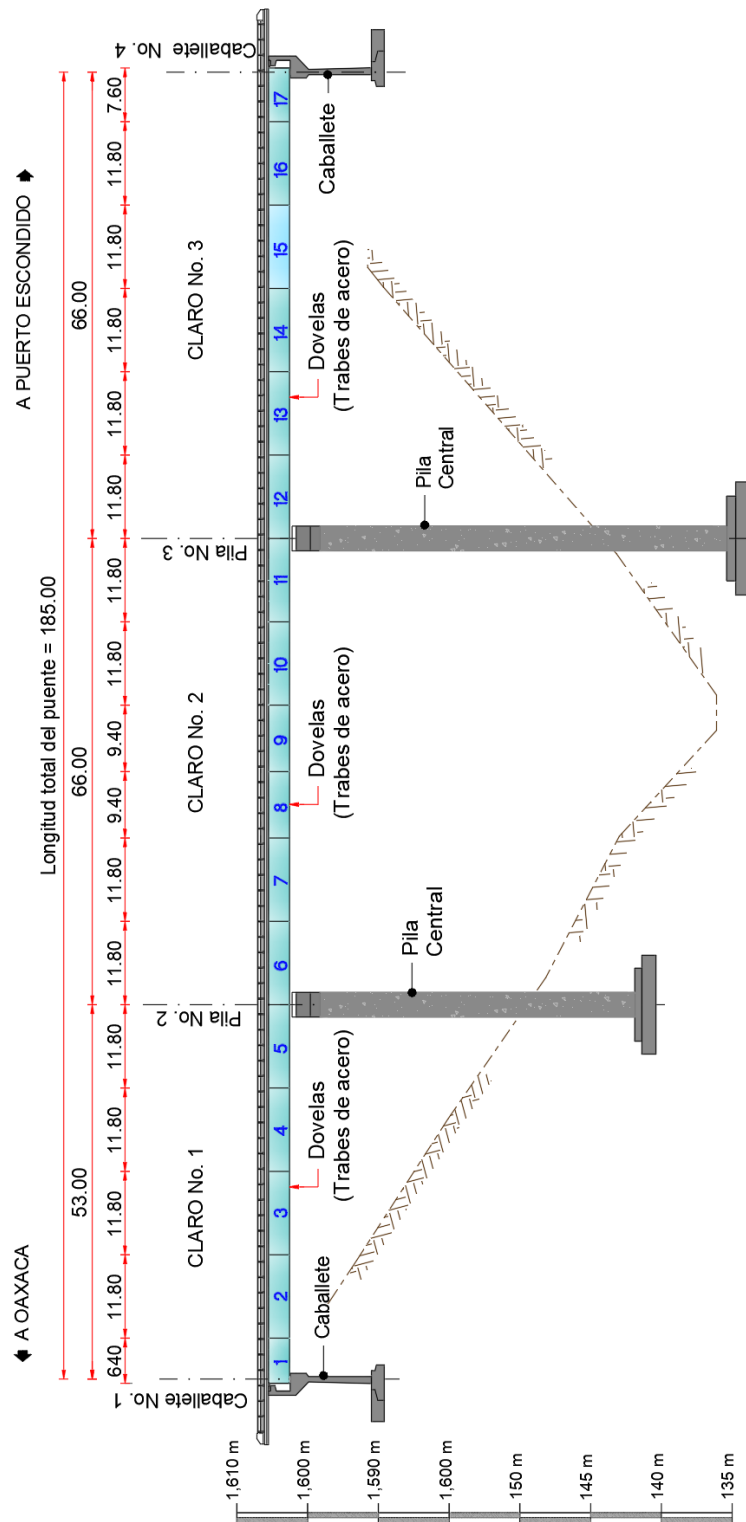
Corte-Elevación por el eje del Proyecto. Fuente: Elaboración propia
